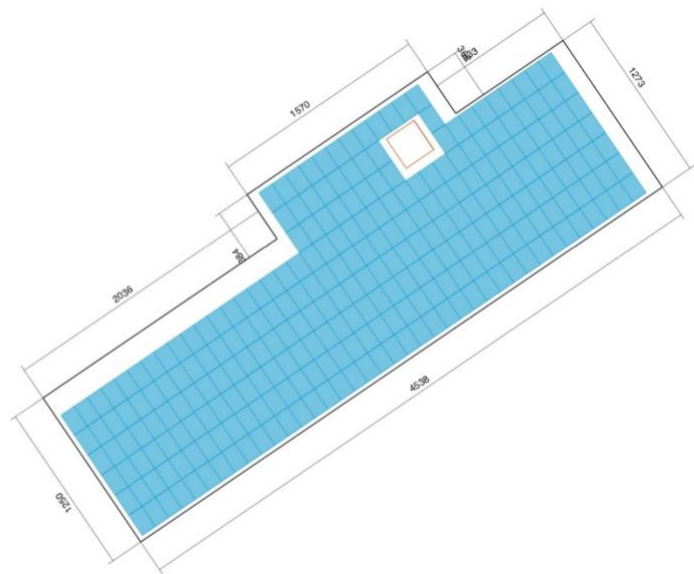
Herrenackerstrasse 29, Belegungsplan, Dachfläche 1
